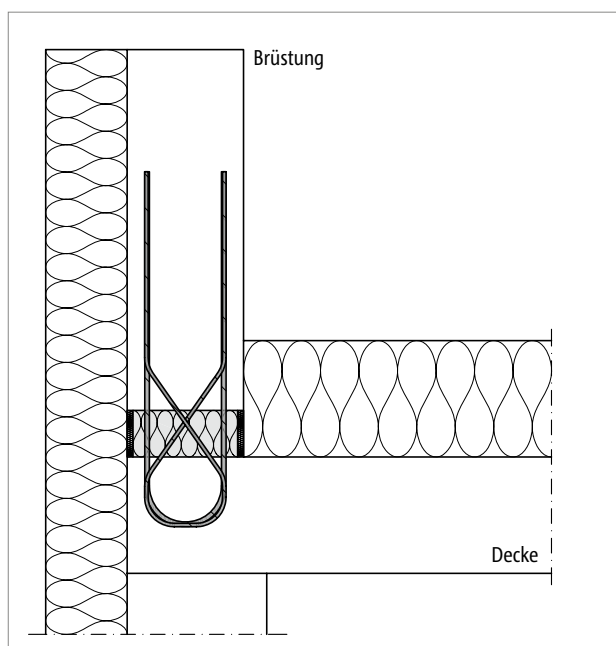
Schöck Isokorb® T Typ AP vertikale Anordnung: Anschluss einer aufgesetzten Brüstung
